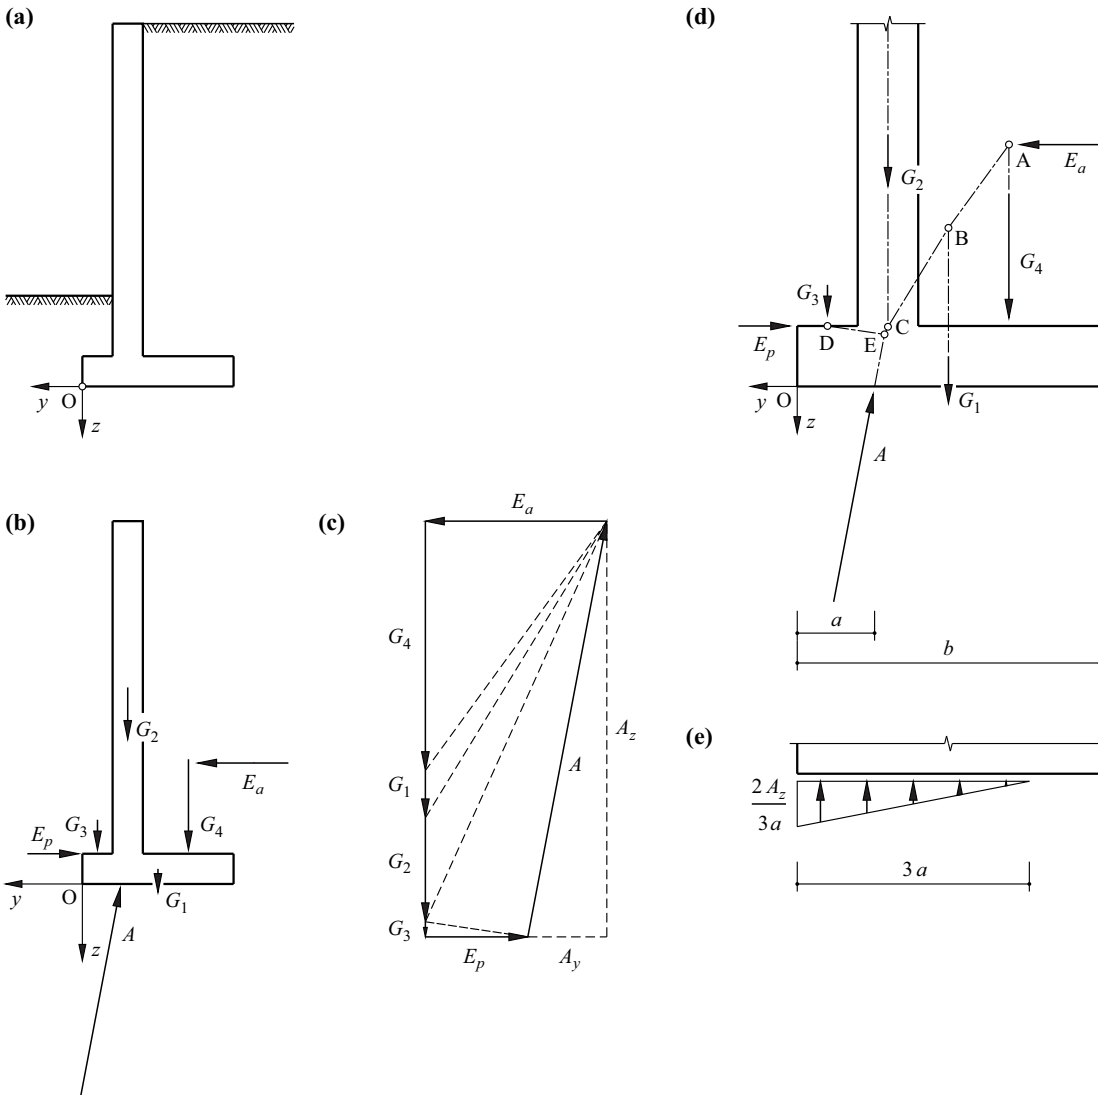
Standfestigkeit einer Winkelstützmauer: (a) Übersicht; (b) Schnittkörperdiagramm; (c) Kräfteplan; (d) Lageplan; (e) mögliche Sohldruckverteilung.
